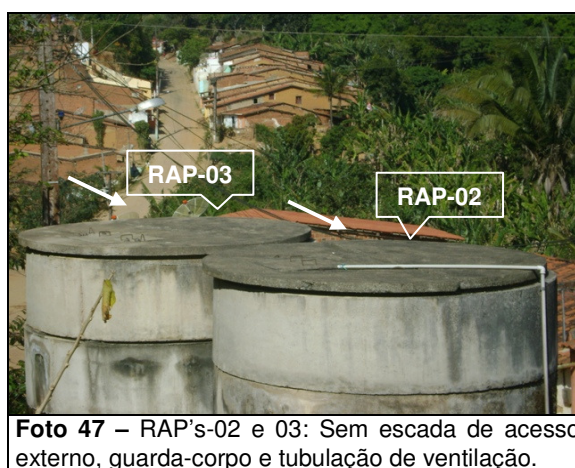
RAP's-02 e 03: Sem escada de acesso externo, guarda-corpo e tubulação de ventilação.
